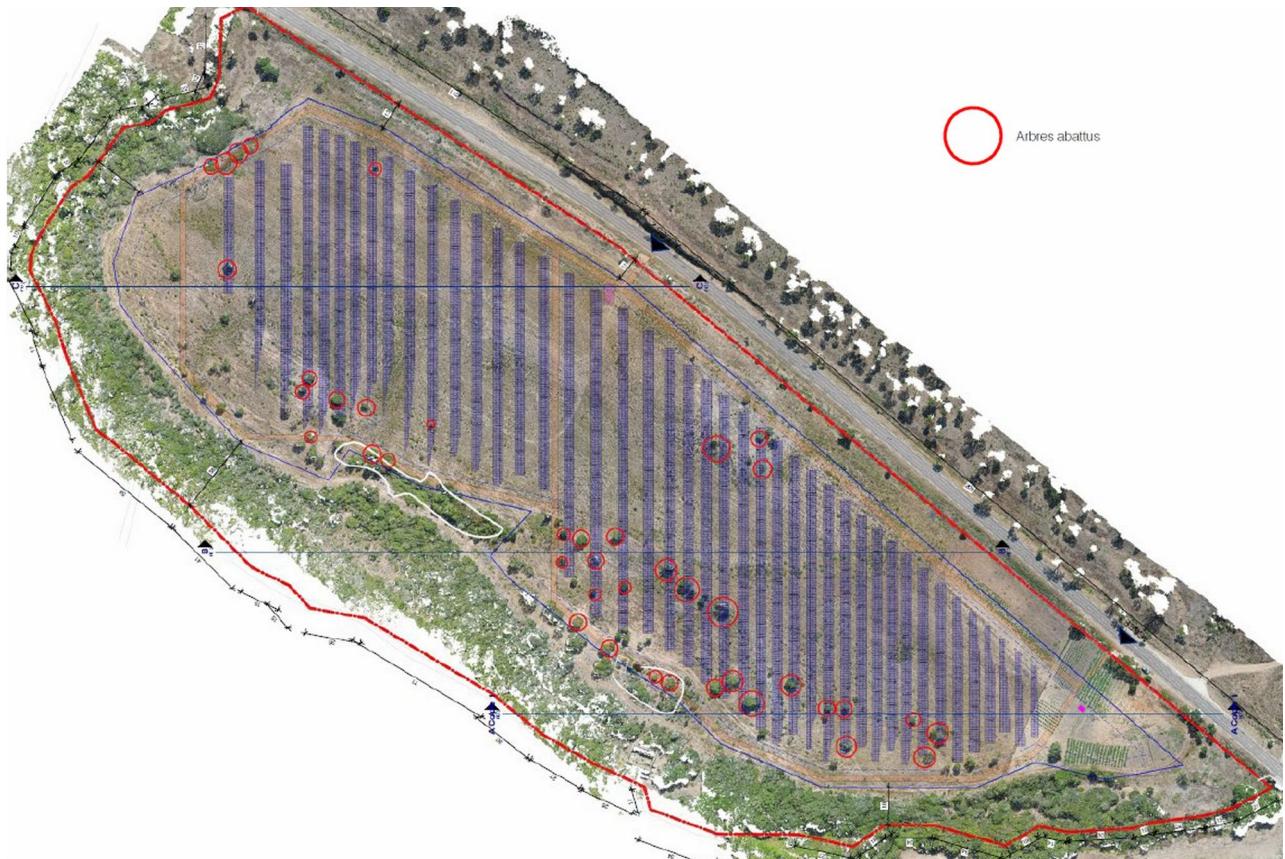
plan paysager du site 1 (source : étude d'impact)
